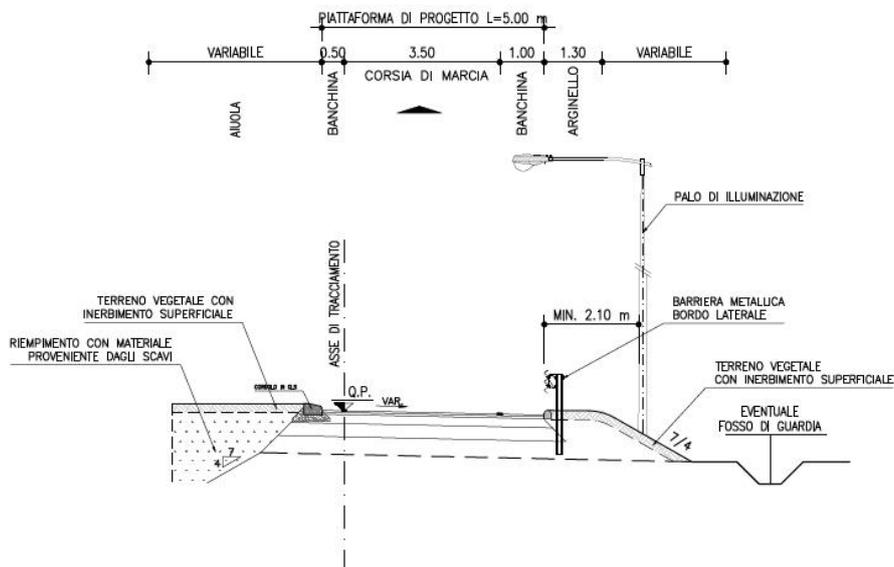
Sezione Tipo ramo di ingresso in rotatoria
